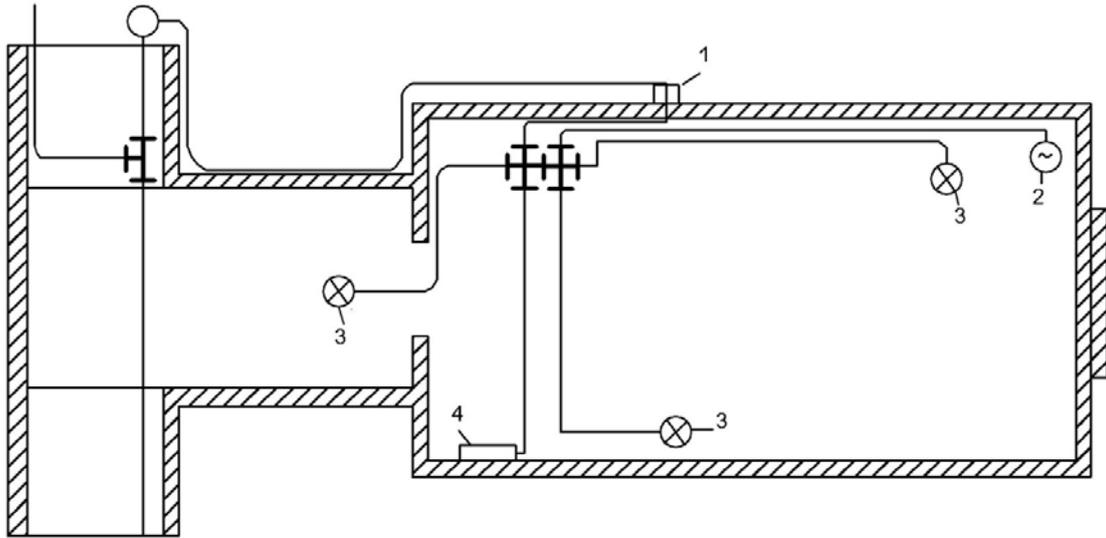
Схема прокладки кабельной сети (вариант), где: 1 – ввод кабеля в сооружение; 2 - электропривод фильтровентиляционной установки; 3 – светильник; 4 - обогреватель
